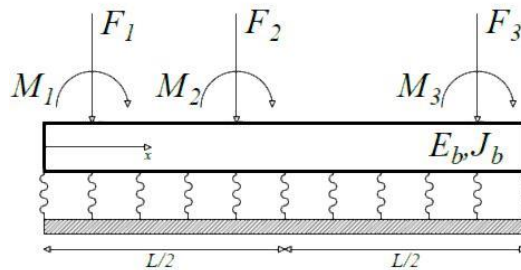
Trave di fondazione molto più rigida del suolo, con carichi applicati.
